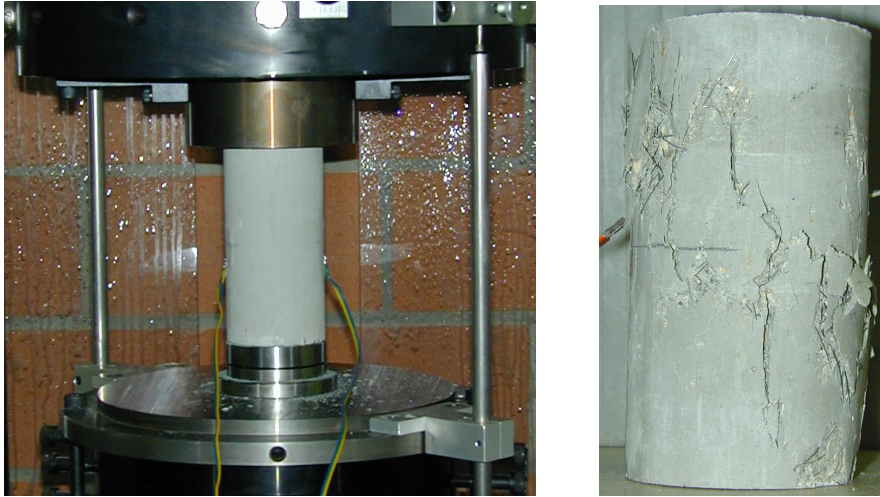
a,b: Versuchsaufbau und geprüfter Druckzylinder mit diagonaler Bruchfuge
